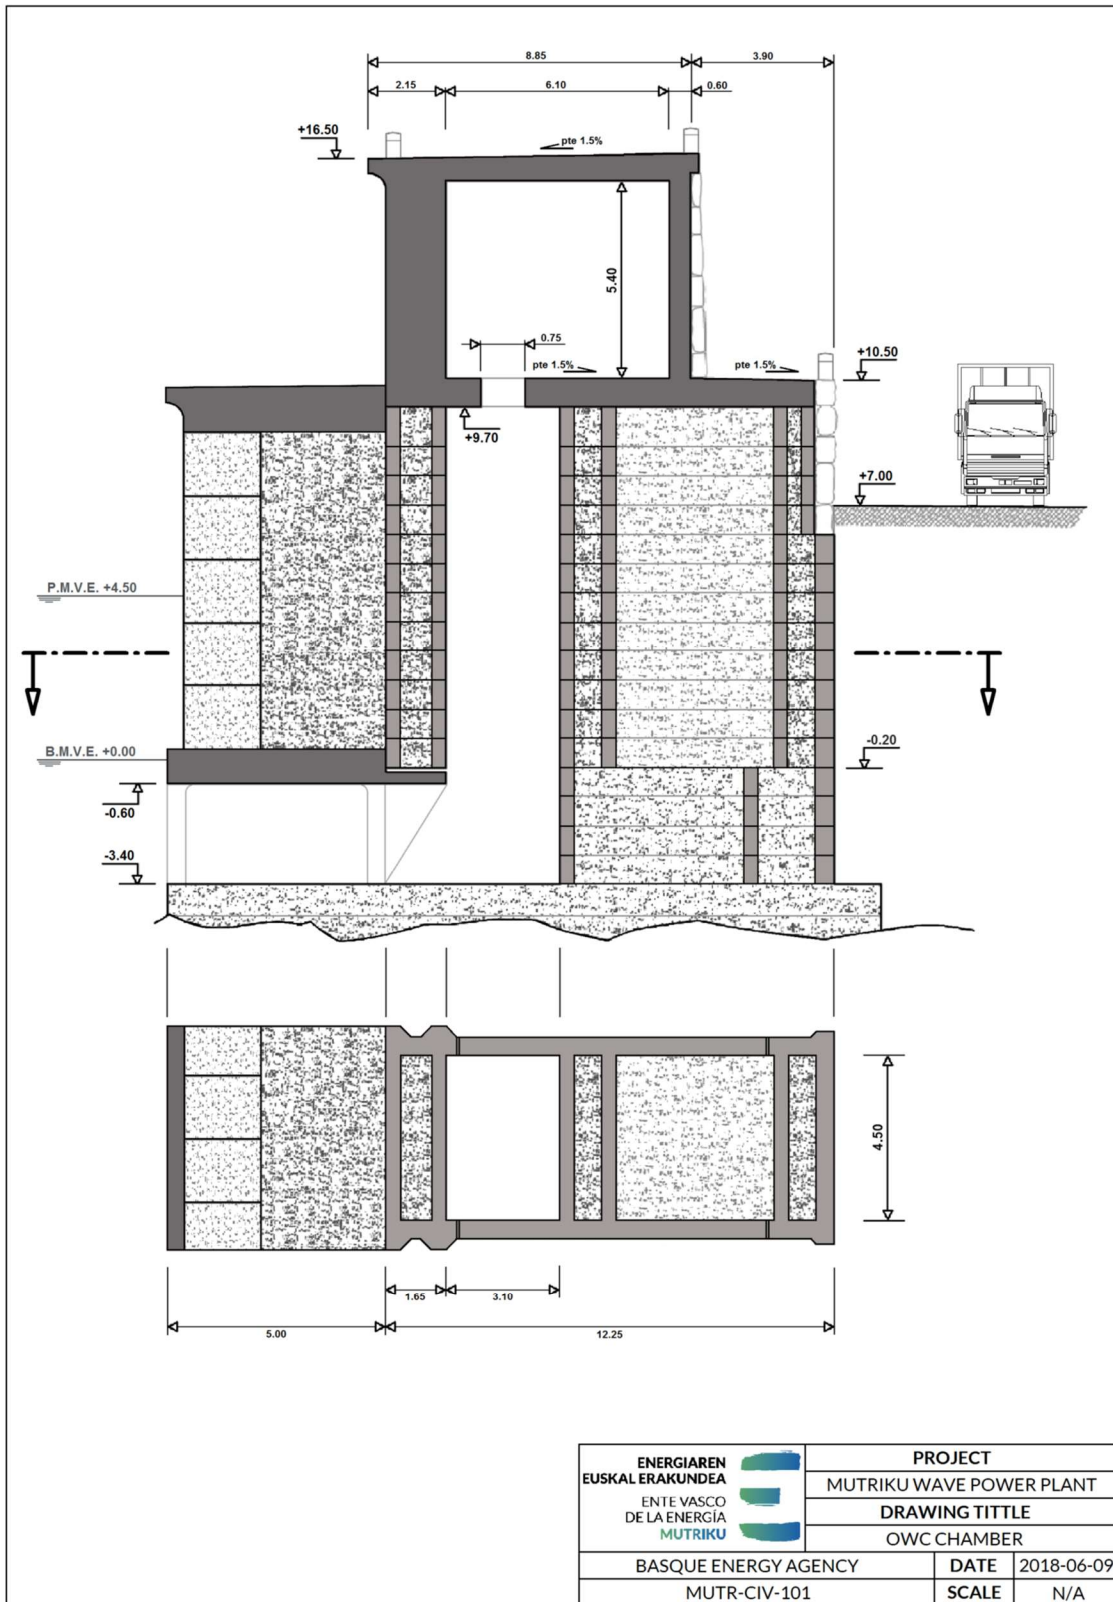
Corte transversal de la planta OWC de Mutriku, España
